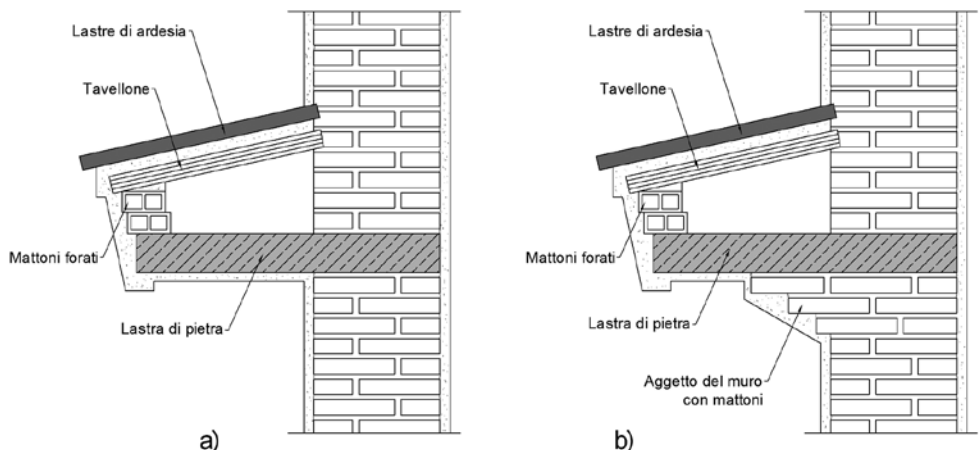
Esempio di cornicione di edificio in muratura portante alleggerito sostenuto da lastra di pietra incastrata nella muratura; b) lastra in pietra su aggetto del muro in mattoni pieni
